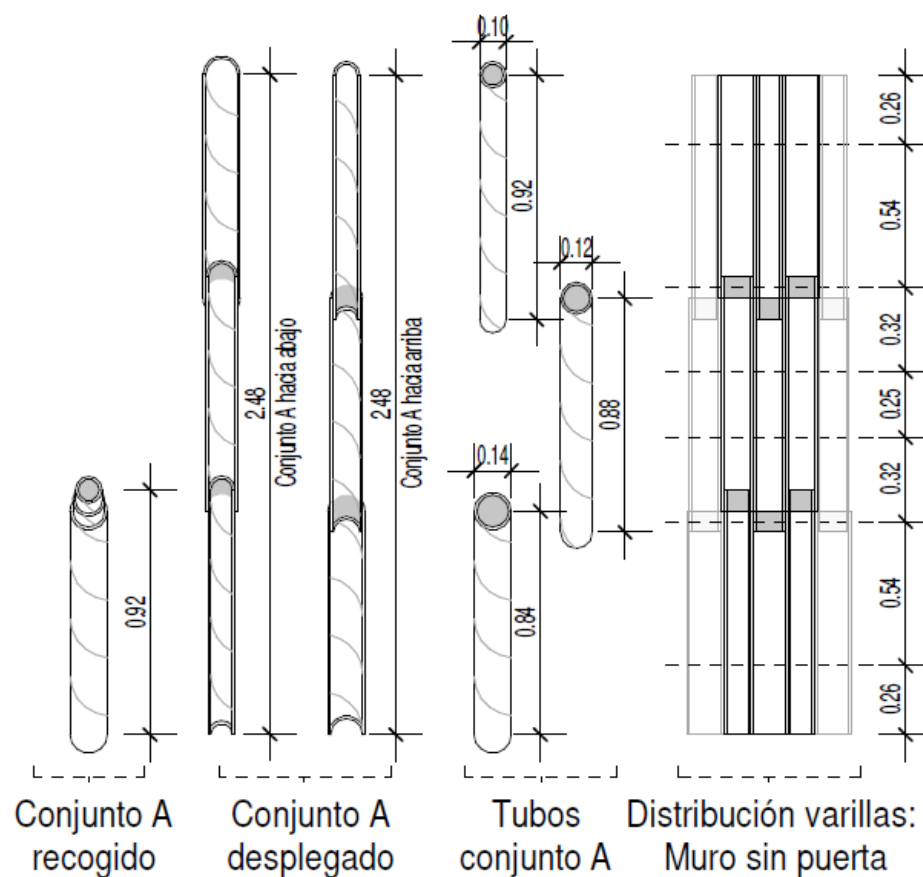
Detalles de Conjuntos y tubos de muros sin puerta. Fuente: Desarrollado por el autor
